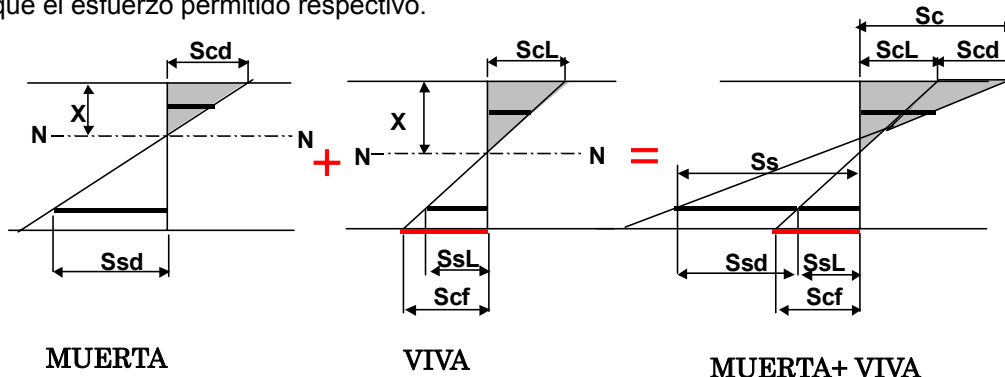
Esfuerzo debido a la Carga muerta y la carga viva
